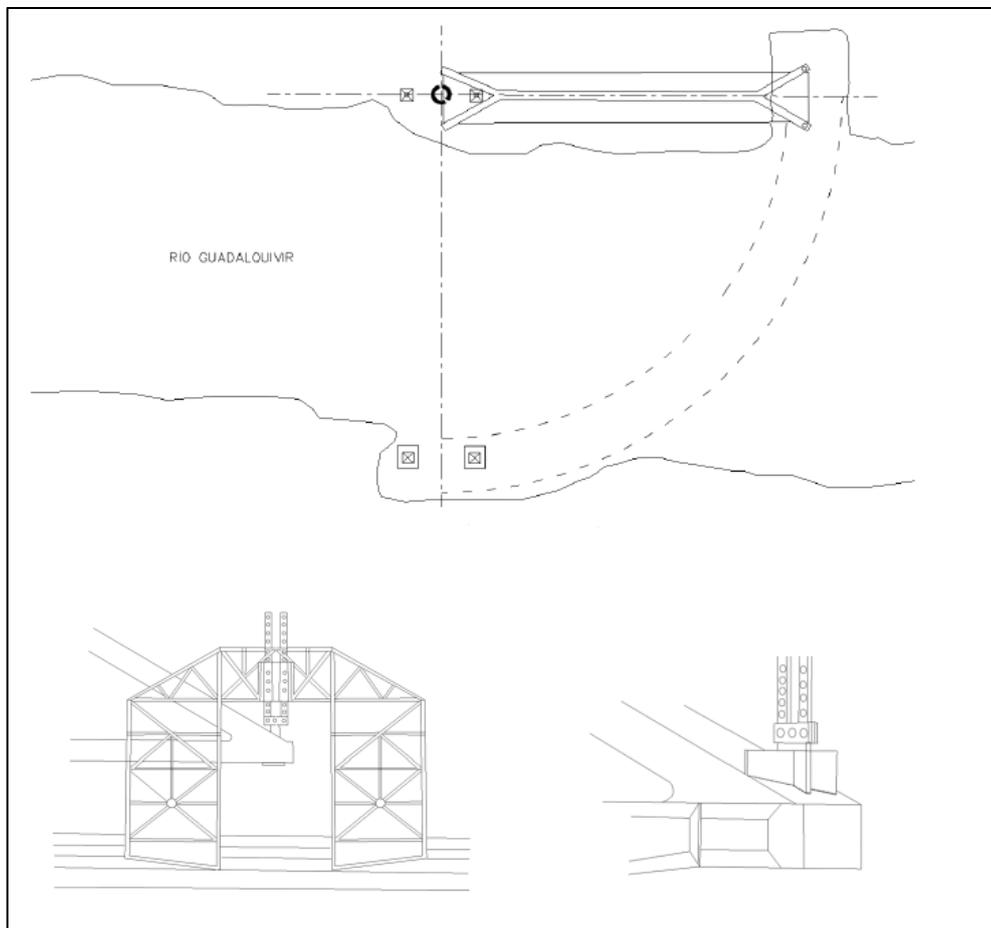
esquema de giro puente de la Barqueta. [4]
